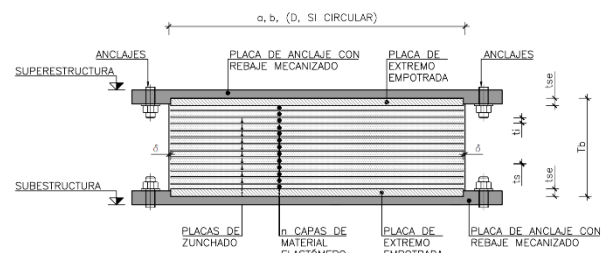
Alzado tipo de un aislador LDRB con anclaje no normalizado mediante empotramiento del aislador en las placas de anclaje
